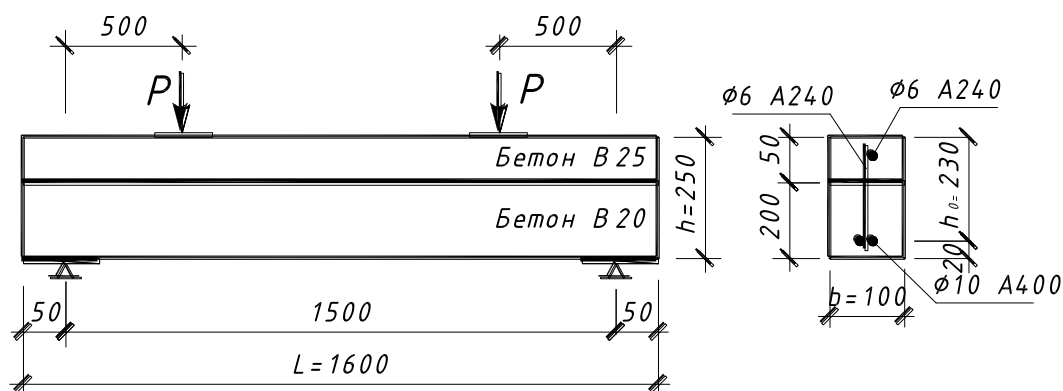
Схема опытной конструкции железобетонной составной балки
